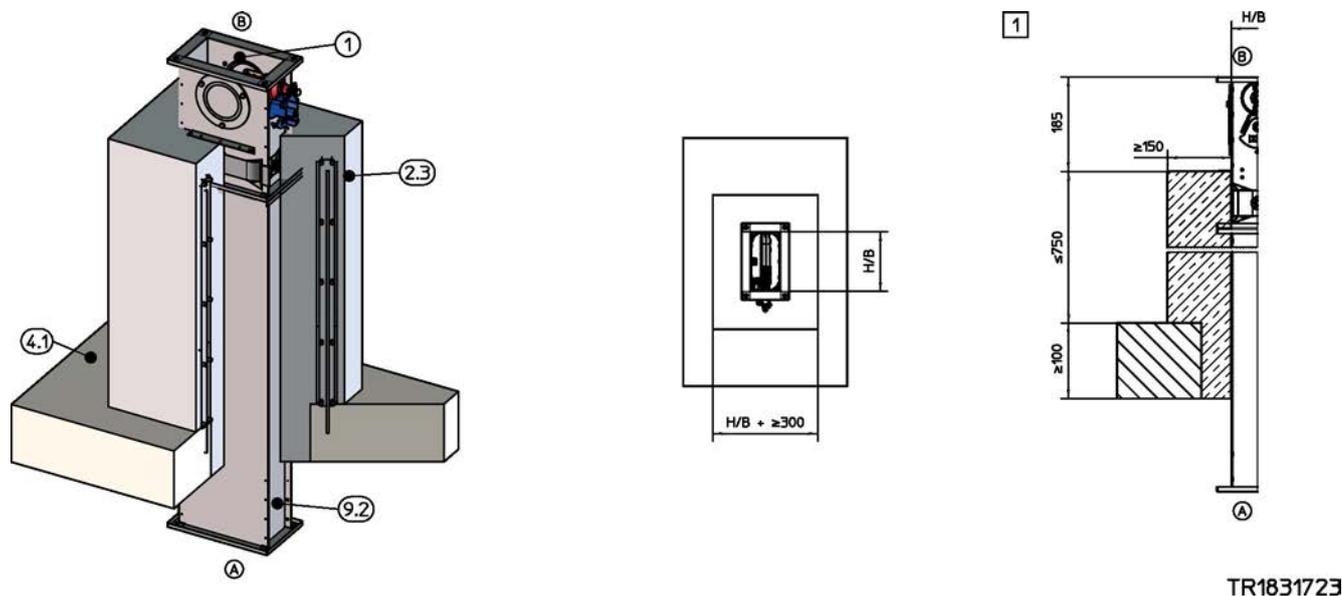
Nasseinbau in Massivdecke mit Betonsockel bis EI 120 S
